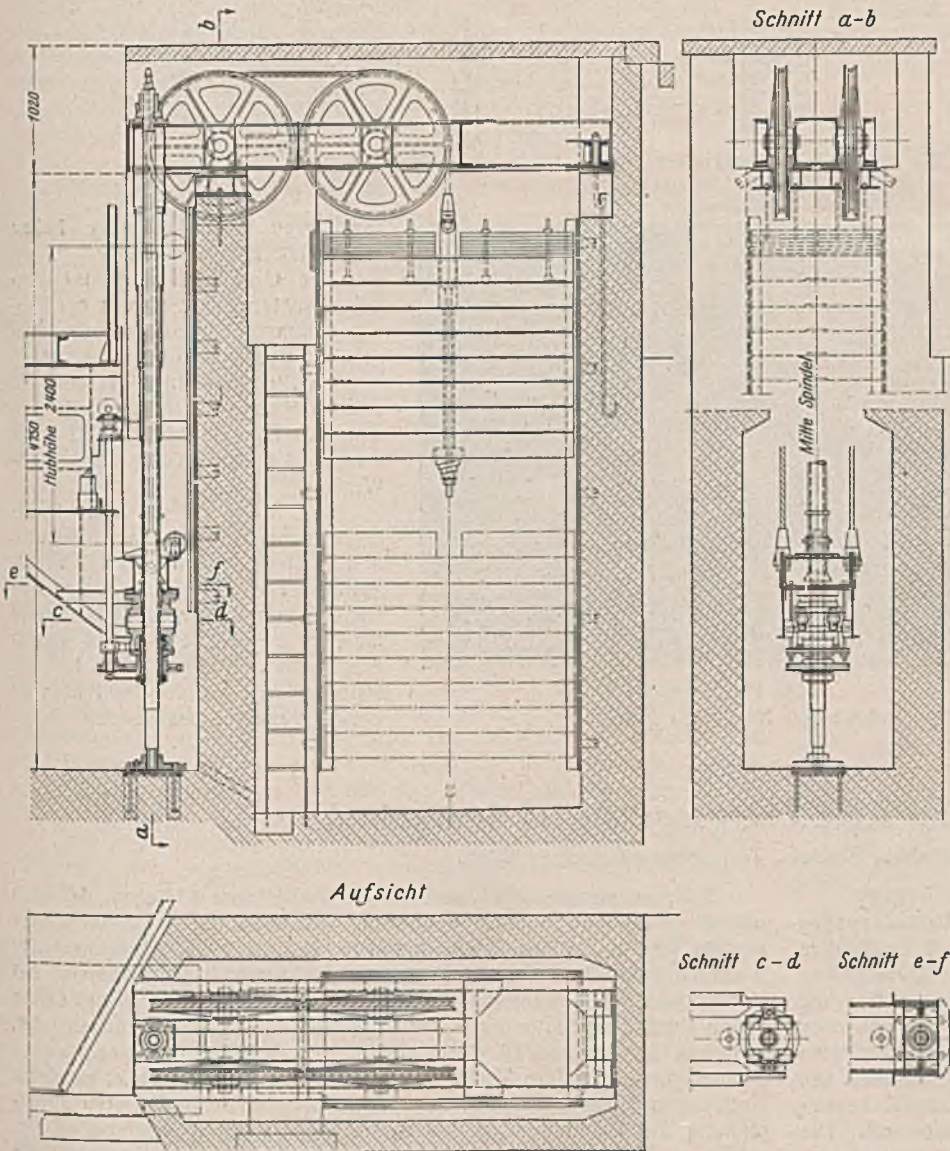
Spindeltrieb und Gegengewichtsaufhängung.
